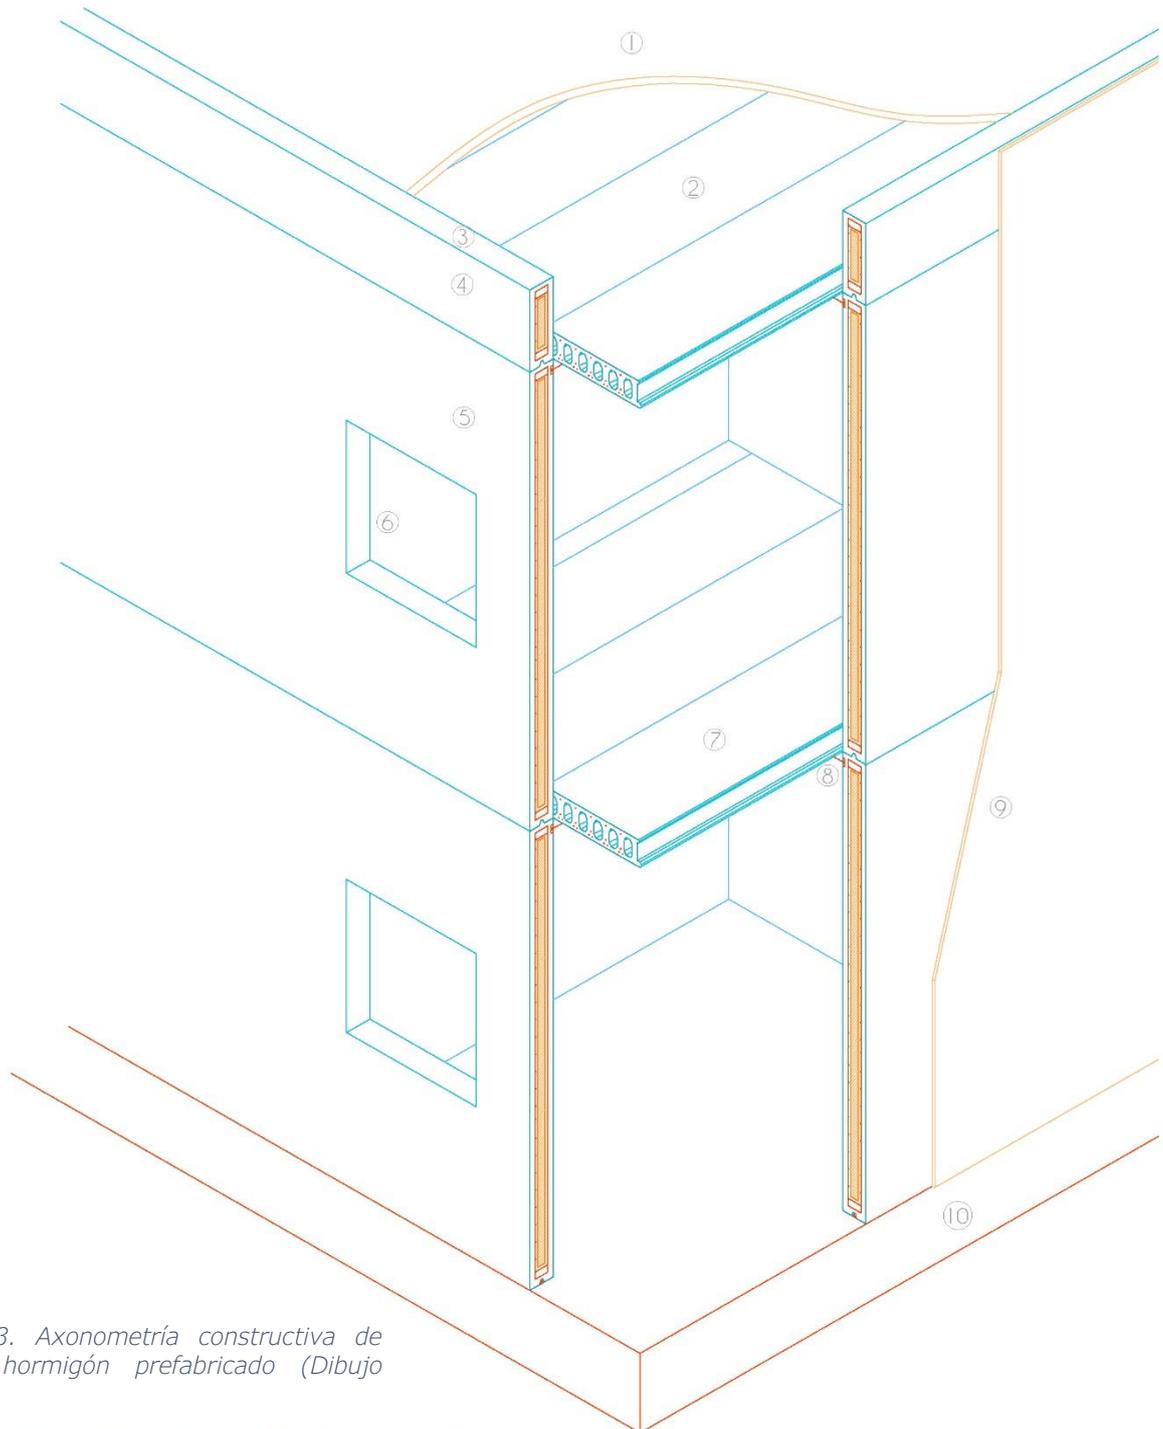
Axonometría constructiva de paneles hormigón prefabricado (Dibujo original)
